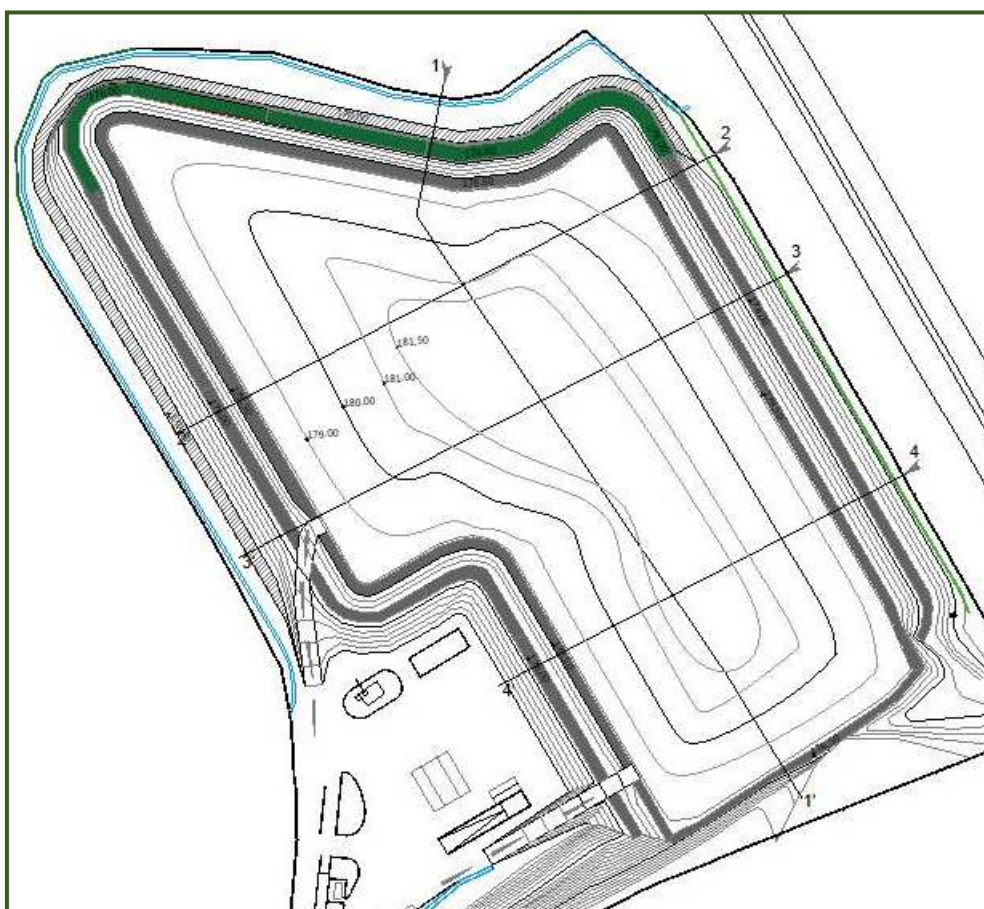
/VI: vista planimetrica delle sezioni di calcolo
